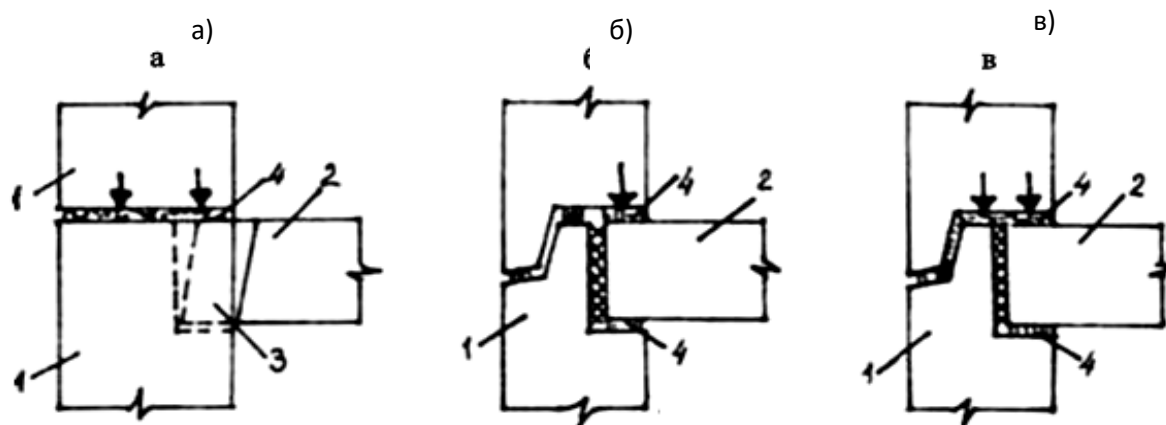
Горизонтальные стыки панелей несущих наружных стен и схемы передачи в них вертикальной нагрузки:
